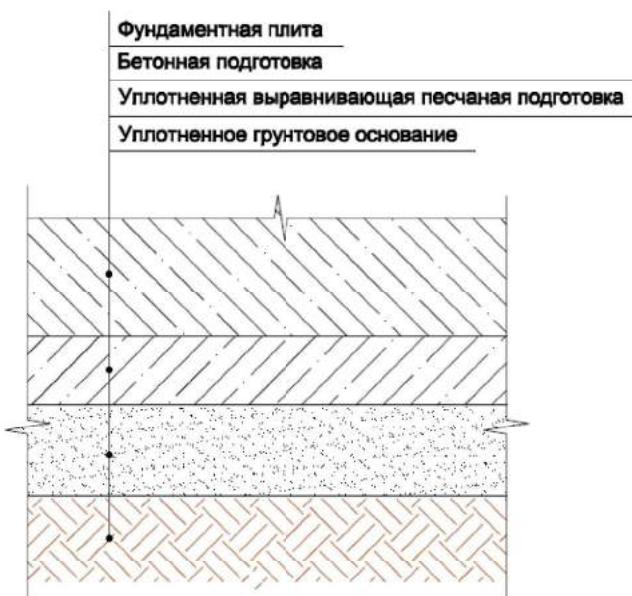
Конструкция фундамента с подготовкой из бетона
